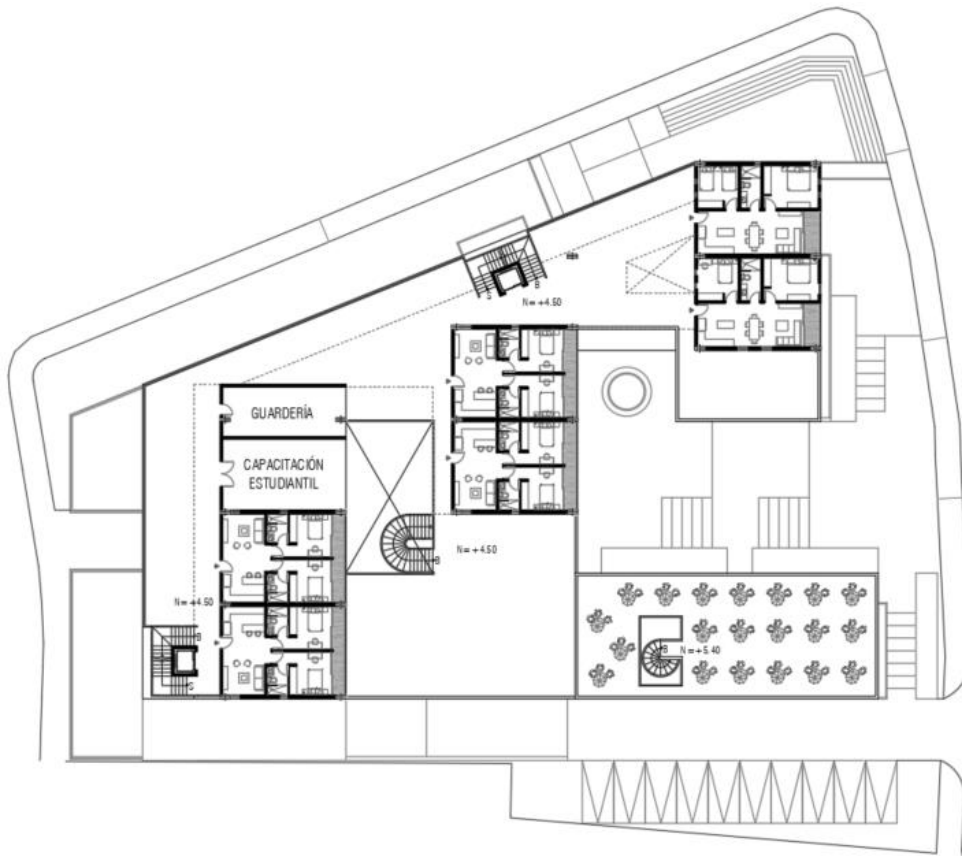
Planta alta 01 - Anteproyecto 02. Elaboración propia.
